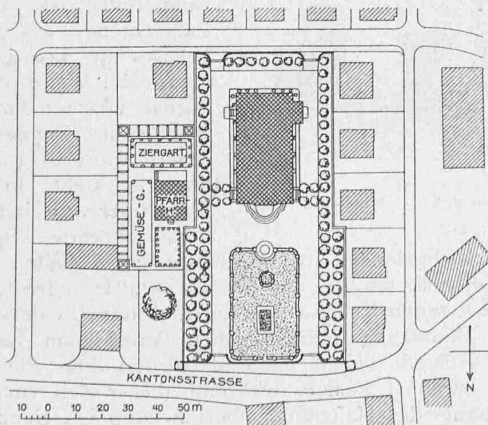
Lageplan von Kirche und projektiertem Pfarrhaus.
